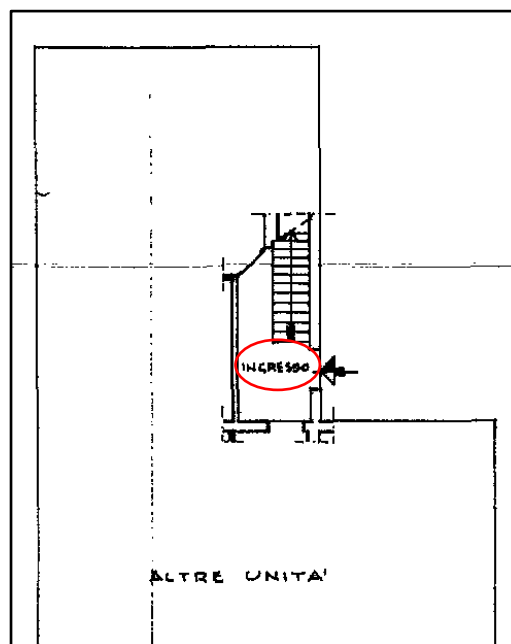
Estratto planimetria catastale del subalterno 3, piano terra
